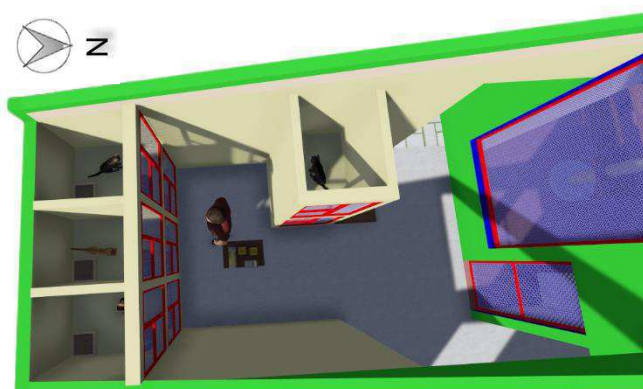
Área de Jaulas de cuarentenas propuesta. Fuente: Propia
